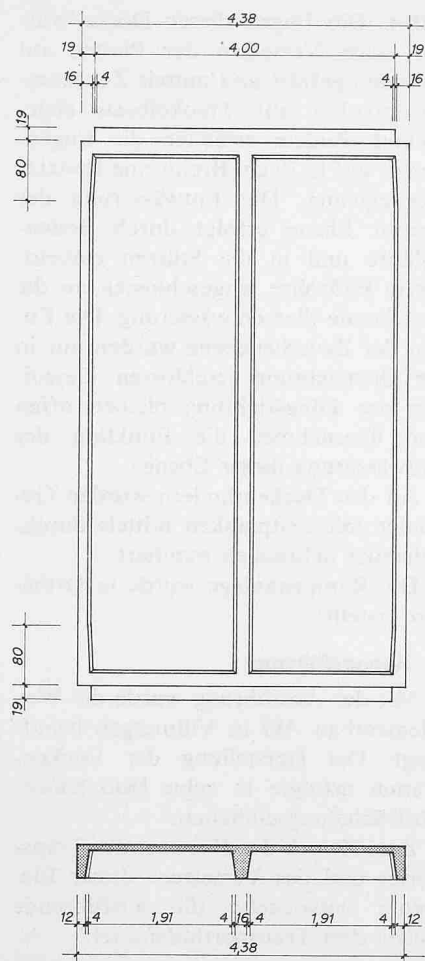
Deckenplatte der ersten Ebene, Massstab 1:100
